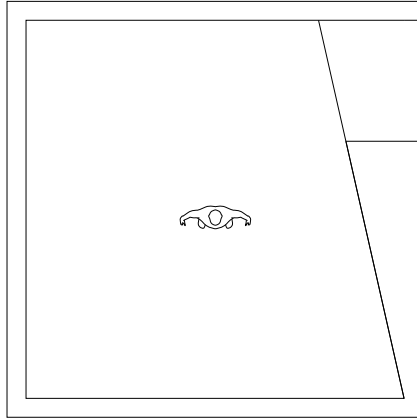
Pos. V.III* | *Grundriss – M.1:100
